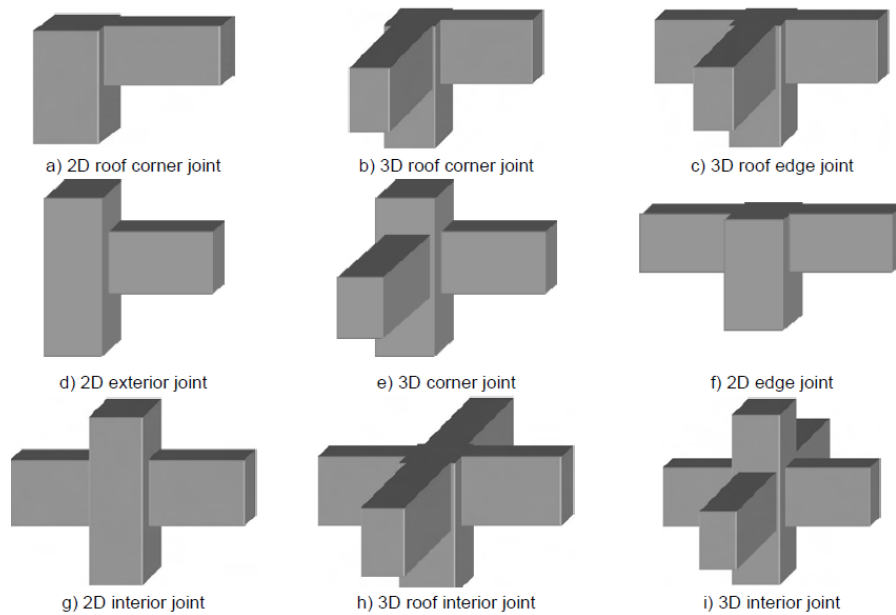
Classification des assemblages poutre-poteau [ACI-318, 2002]
